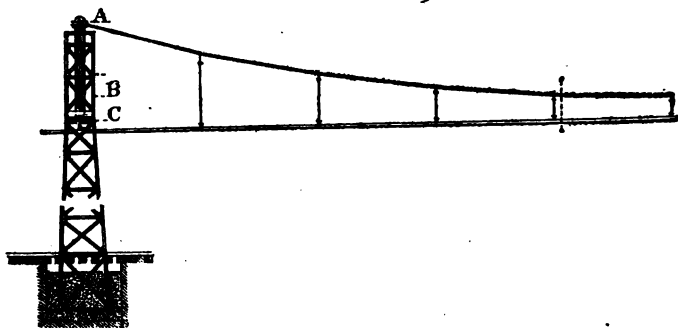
Coupe longitudinale de la suspension des conducteurs en alignement droit.
